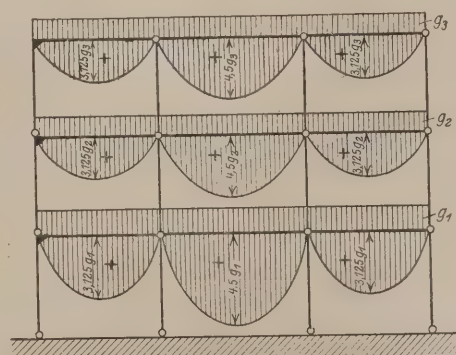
Momentenfläche infolge Eigengewicht am Grundsystem.
